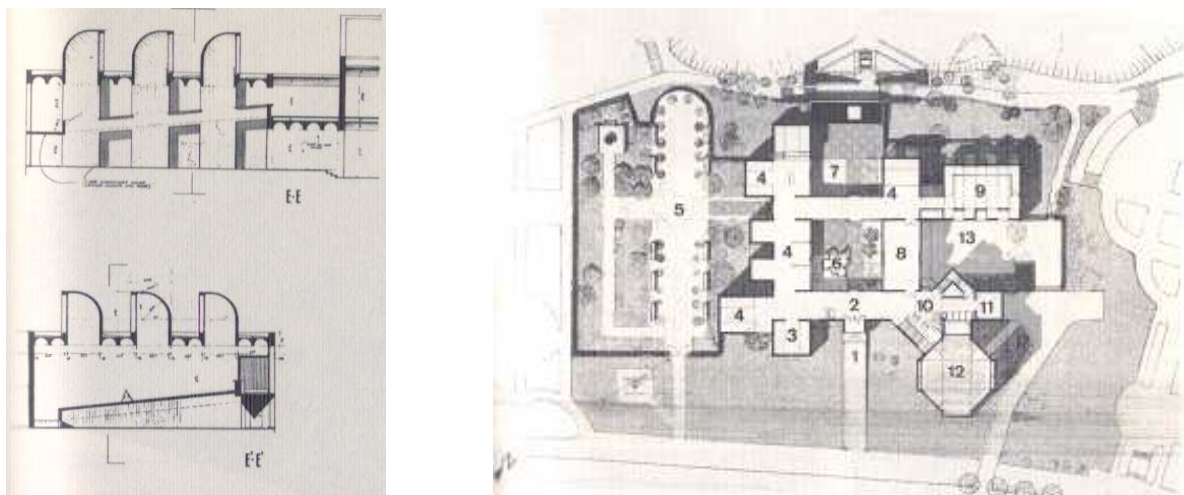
Plantas, alzados y sección originales de proyecto del Museo del Prado.
